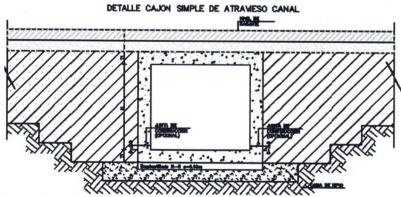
Detalle Sección Transversal Canal Población Tramo 2, Zona Sur. Fuente: Plano BIP Nº 40001003-0. Detalle de Canales Población 2 – Av. Einstein (Tramo Sur). Abril 2021.
